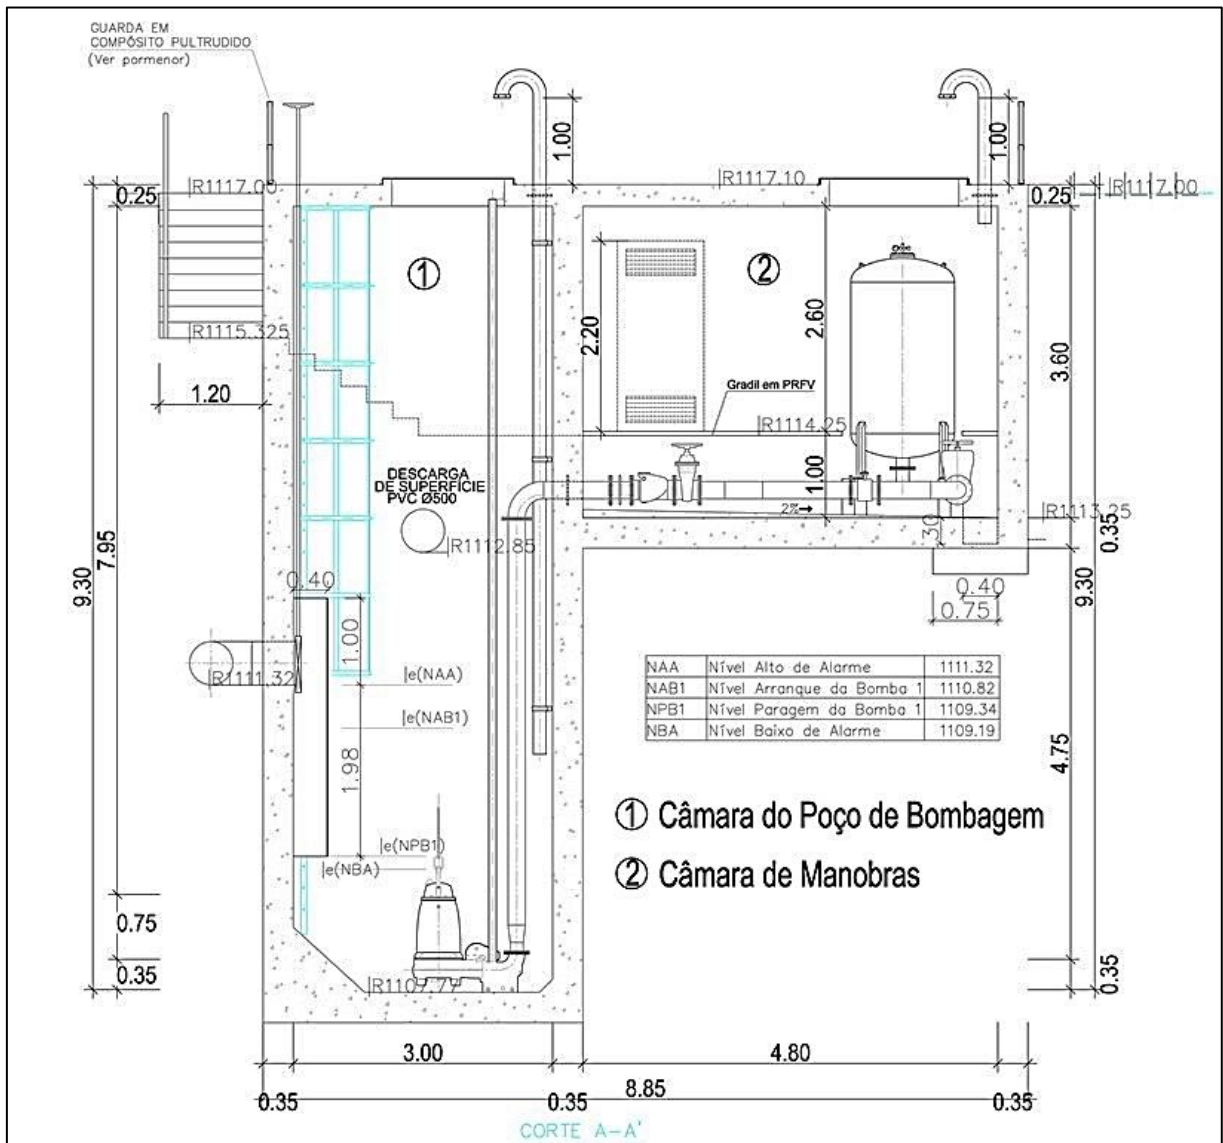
CORTE TRANSVERSAL DAS ESTAÇÃO DE ELEVAÇÃO, (ADAPTADO VALOR AMBIENTE, (2010)).
